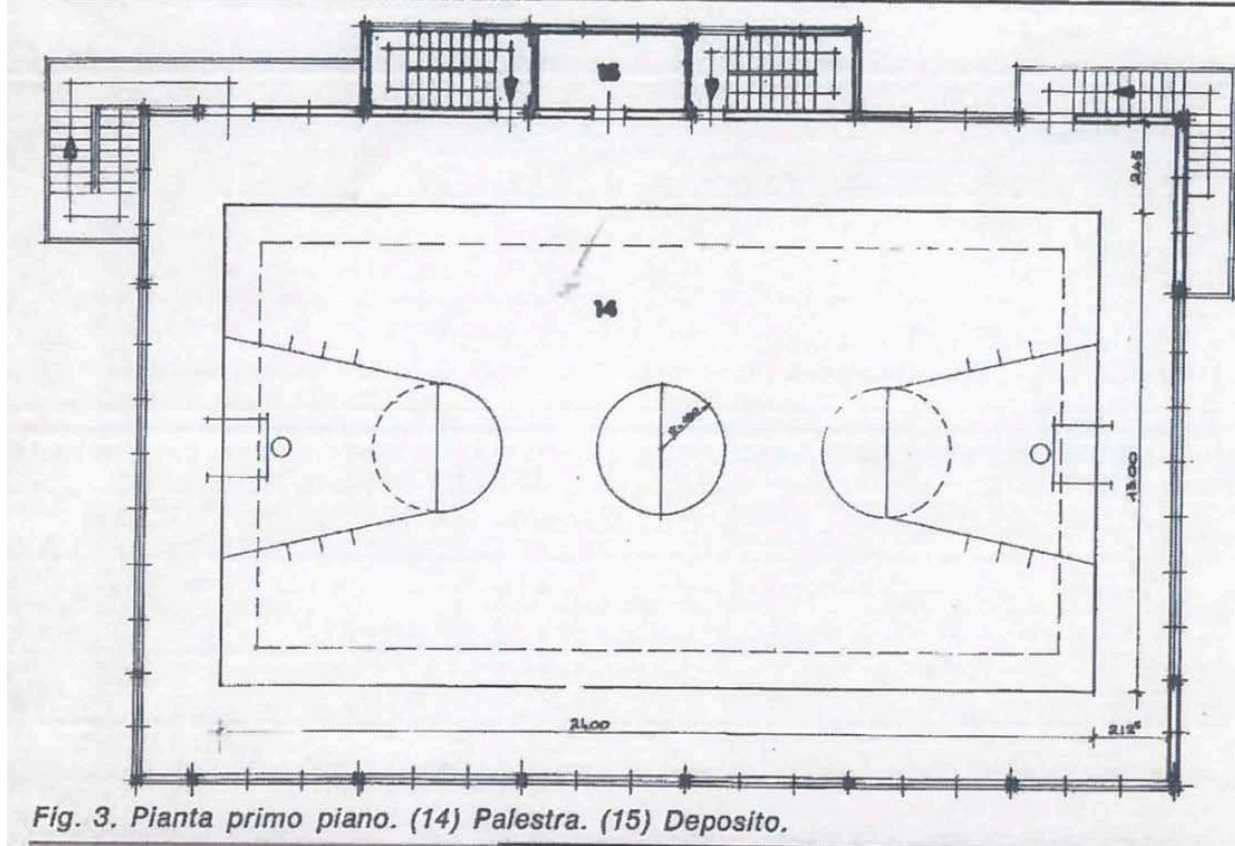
Pianta primo piano. (14) Palestra. (15) Deposito.
